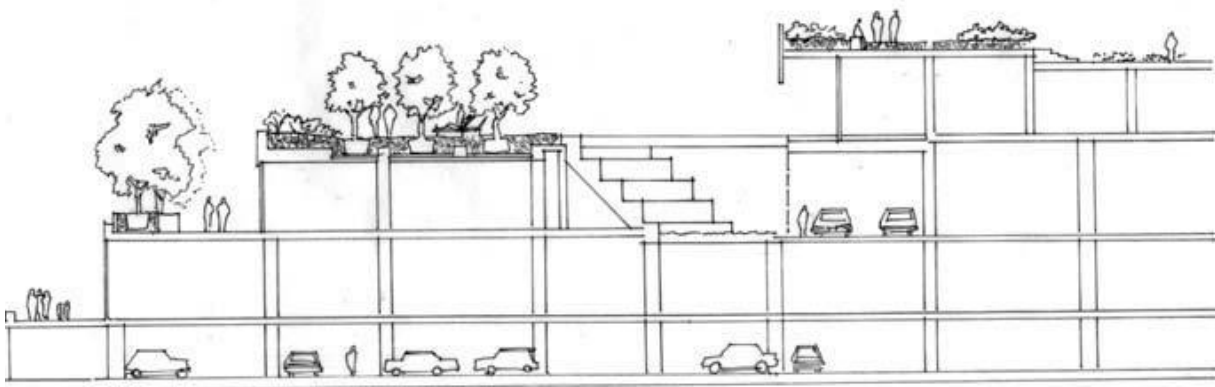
Esquema de coberturas ajardinadas aos vários níveis a que podem existir. Fonte: Green Roof Systems - A Guide to the Planning, Design, and Construction of Landscapes over Structure Susan K. Weiler Katrin Scholz-Barth p.86
